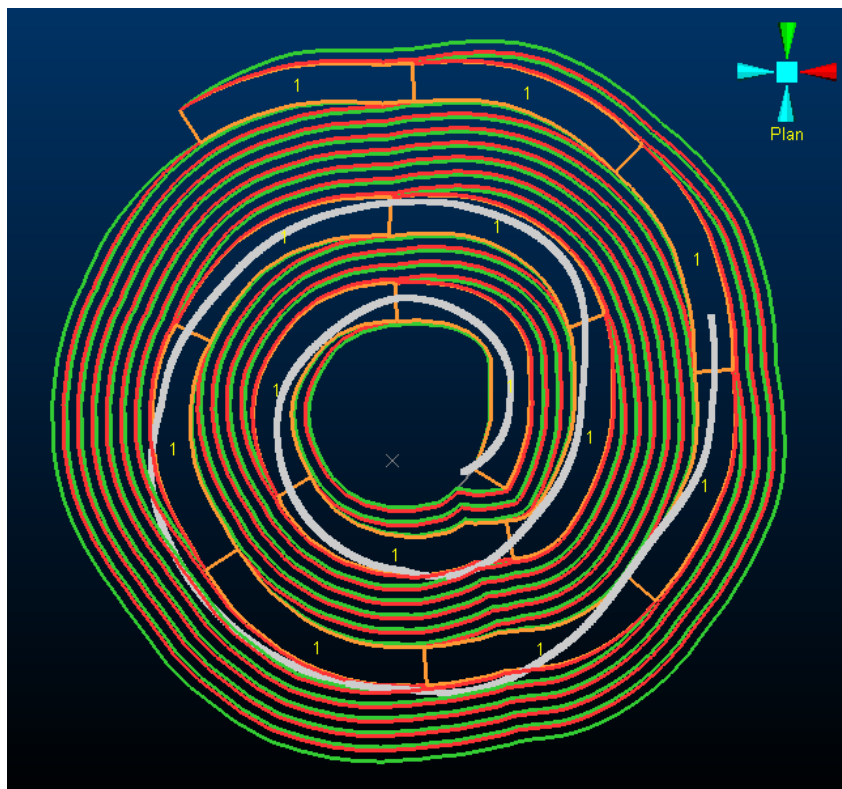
Vista planta ajuste pit suavizado y línea de puntos.
